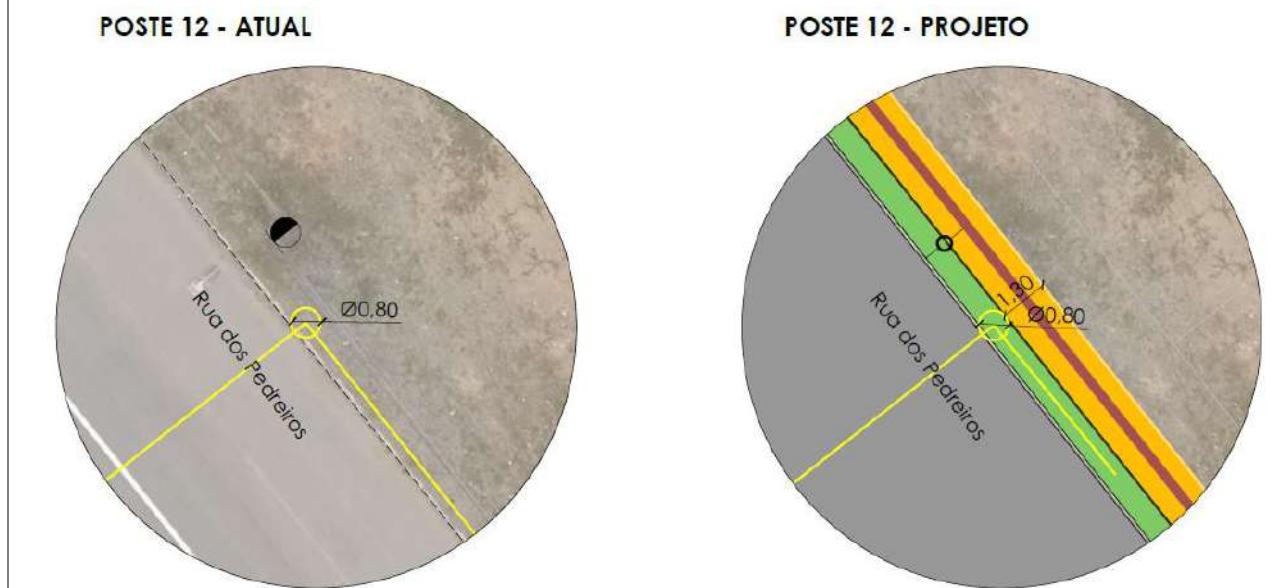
Exemplo de estrutura instalada na faixa de serviço. Fonte: Planta de locação dos postes.
